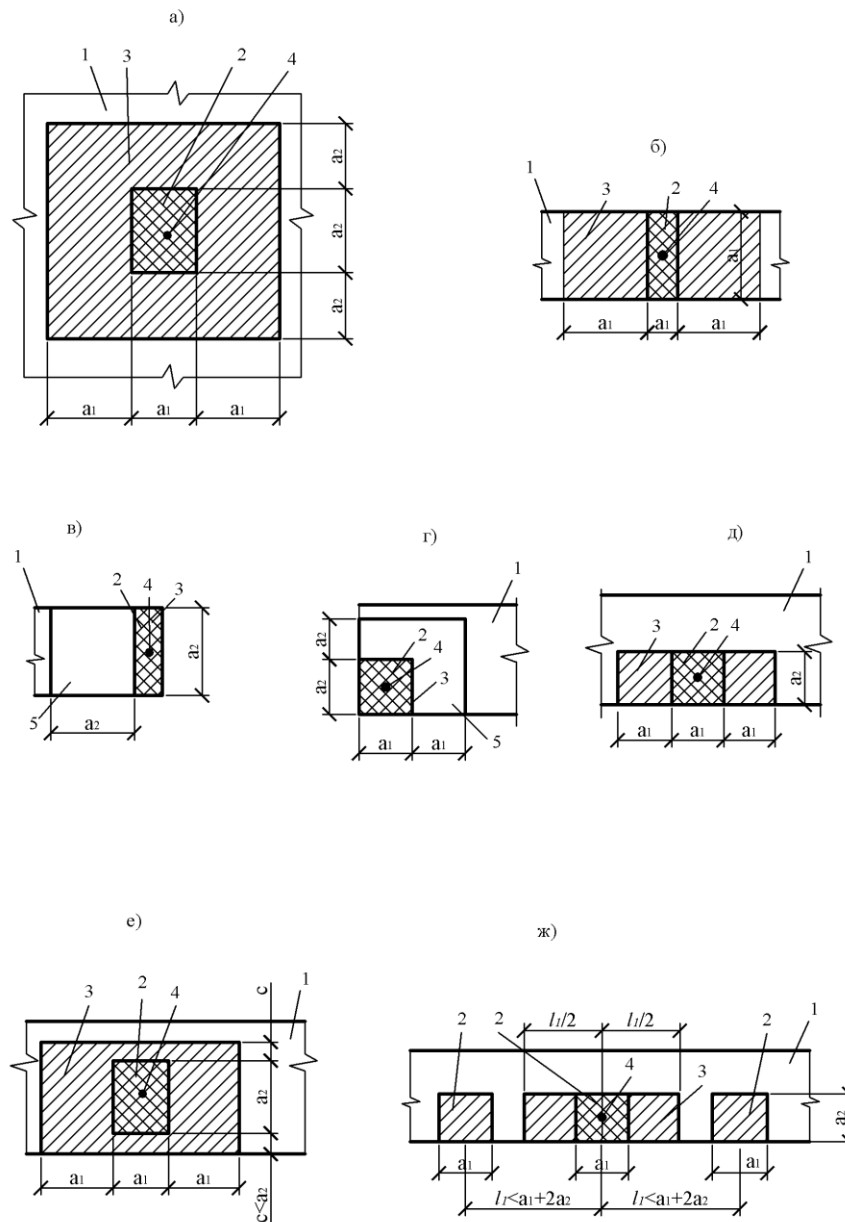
Схема для расчета элементов на местное сжатие при расположении местной нагрузки
